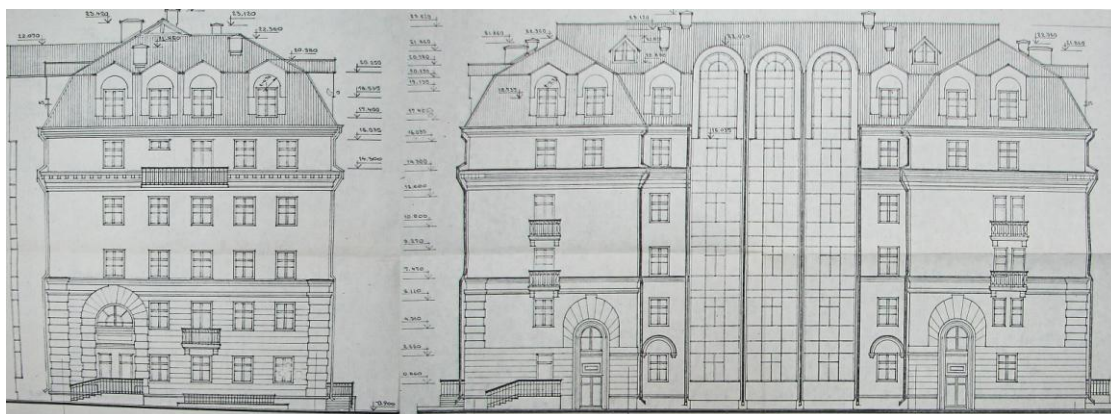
Чертежи торцового и дворового фасадов жилого дома по пр. Мира, д. 122Б
